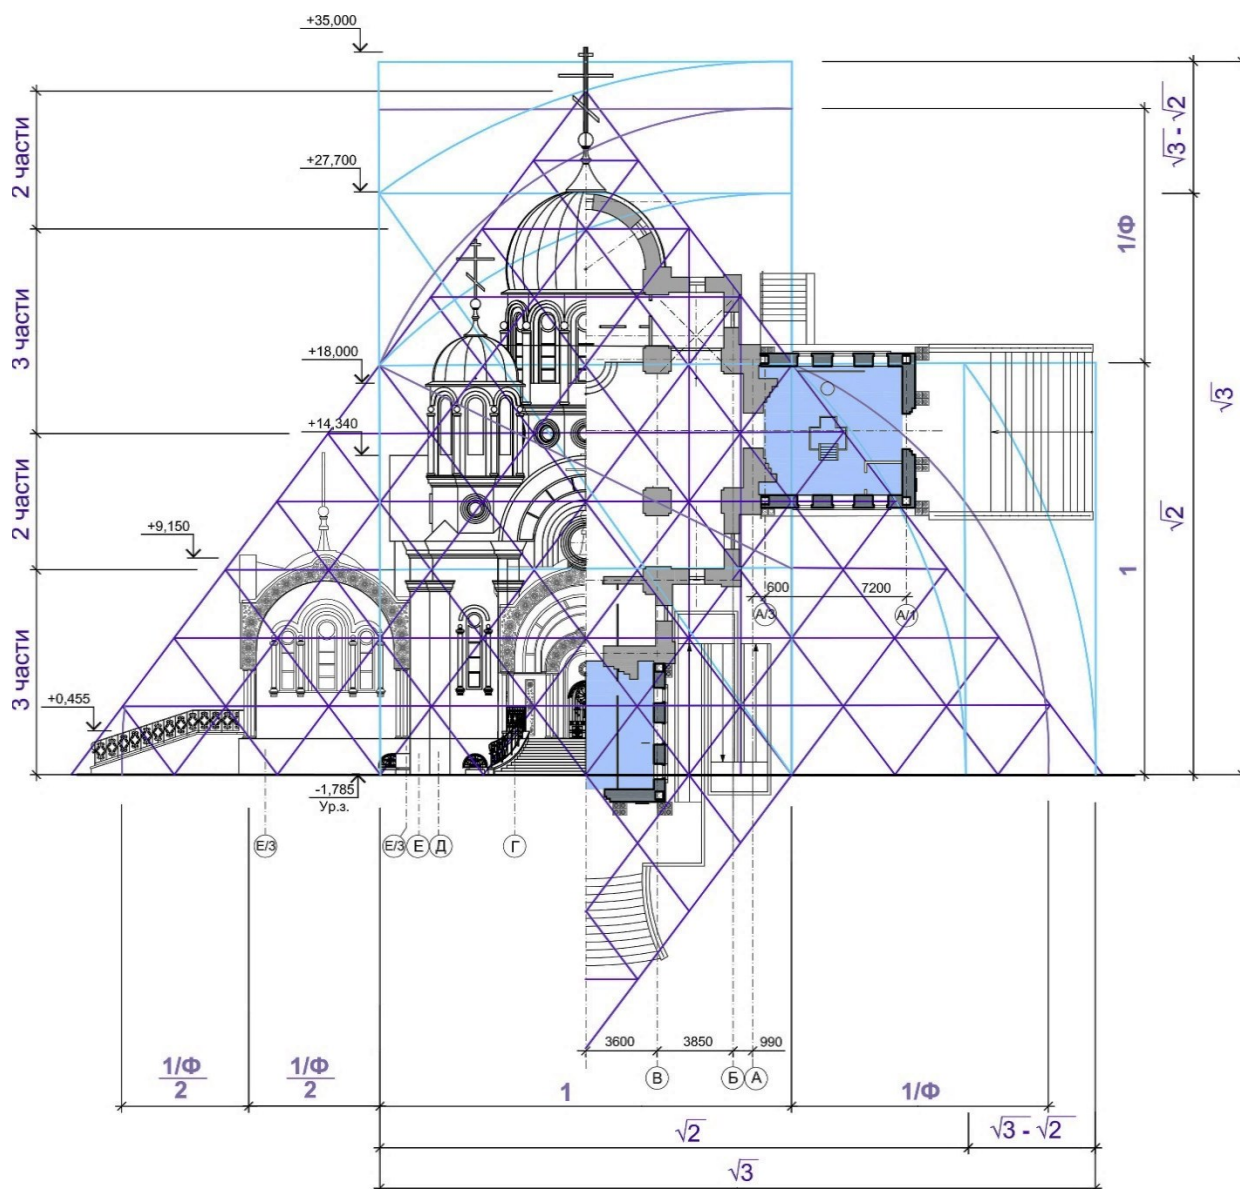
Совмещенная схема фрагмента фасада Е/3–А и плана первого этажа после реконструкции с выявлением пропорциональных зависимостей с помощью золотого сечения, метода триангуляции и динамических прямоугольников Джея Хэмбиджа с соотношением сторон $1 : \sqrt{2}$ и $1 : \sqrt{3}$
